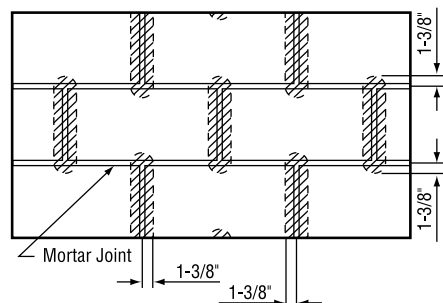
Instalación en una unidad de mampostería de concreto rellena con lechada
